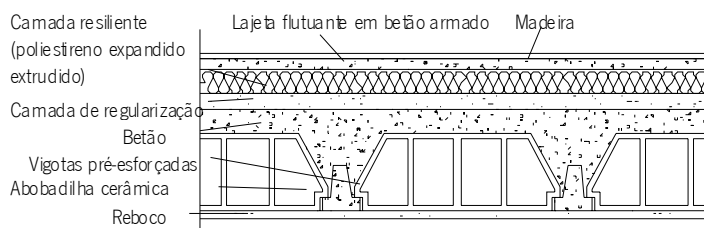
Corte esquemático do pavimento aligeirado com uma lajeta flutuante
